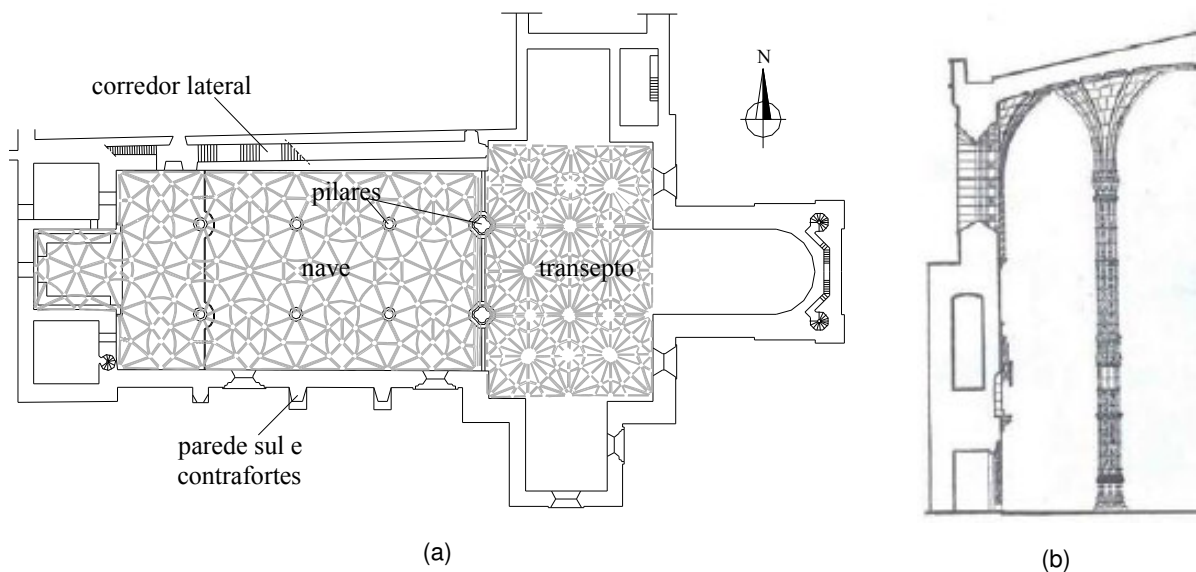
Planta da Igreja: (a) abóbadas da nave e do transepto; (b) secção transversal da parede Norte.
